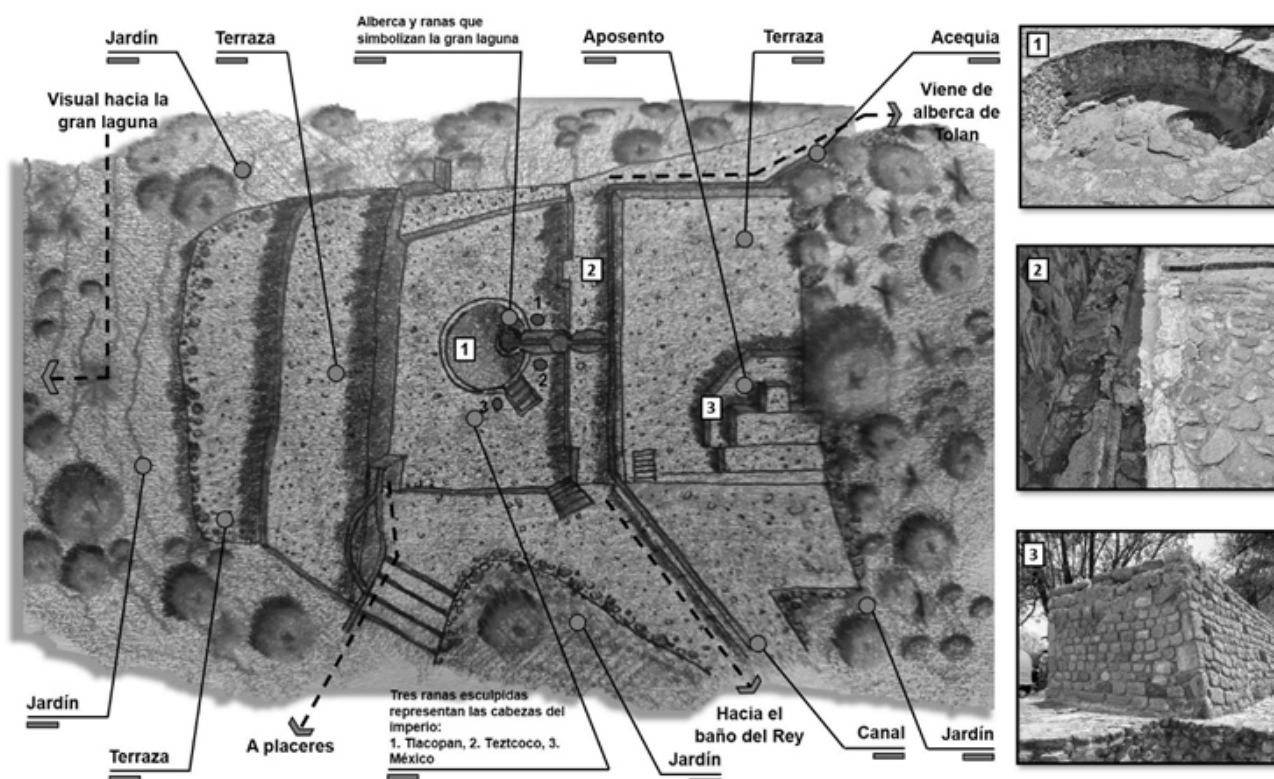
Vista en planta del baño de la reina, ubicado al noroeste del cerro.¹
